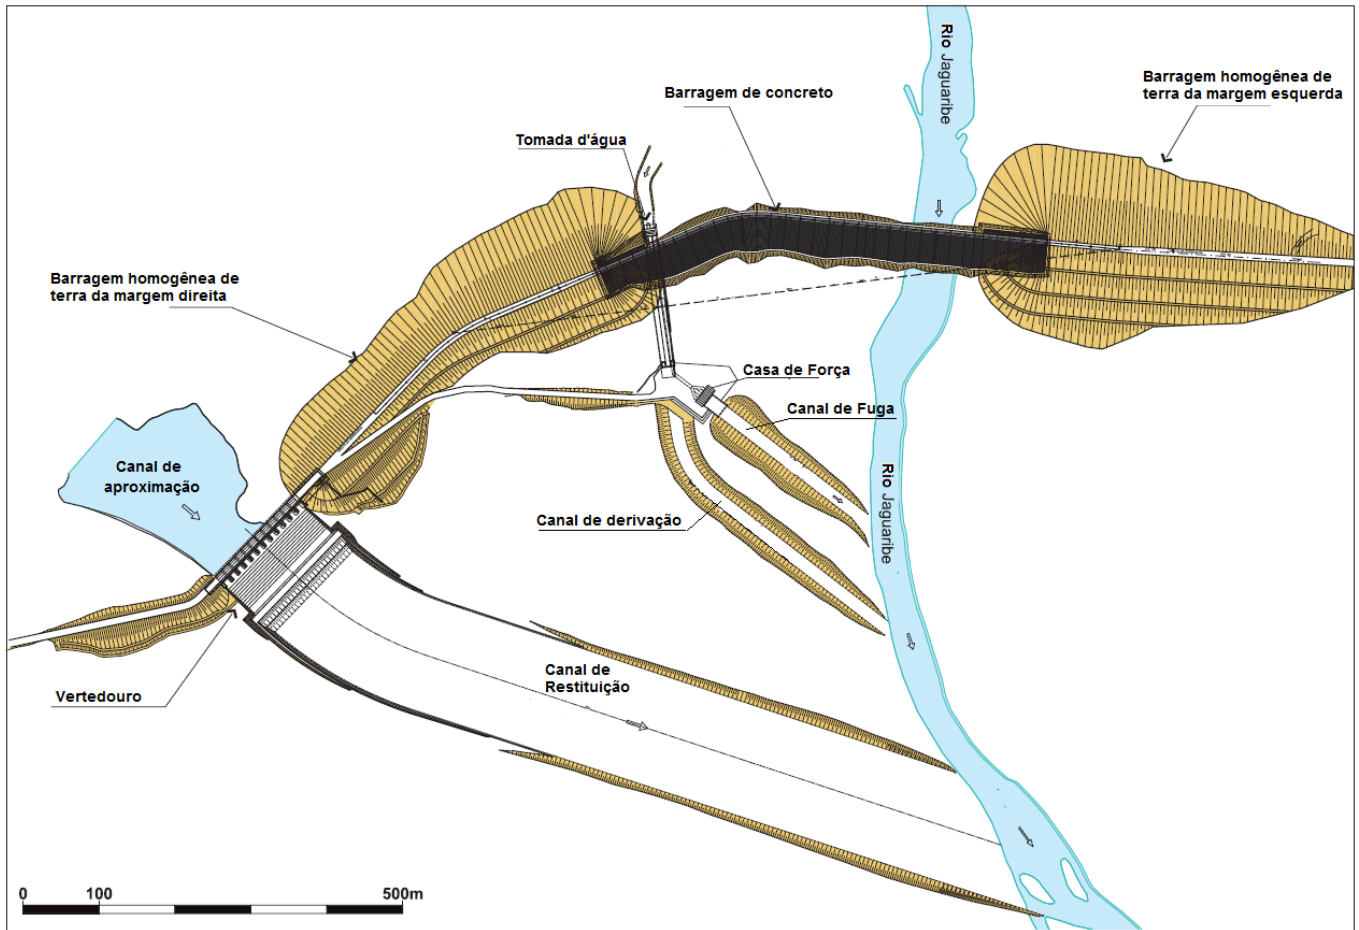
Arranjo geral da barragem de Castanhão (PONTE et al, 2009)
